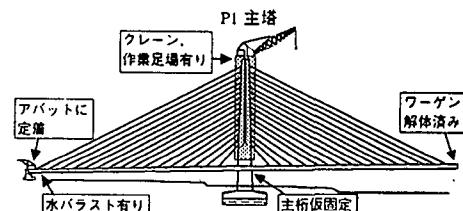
平成6年北海道東方沖地震発生時における十勝大橋の施工状況
